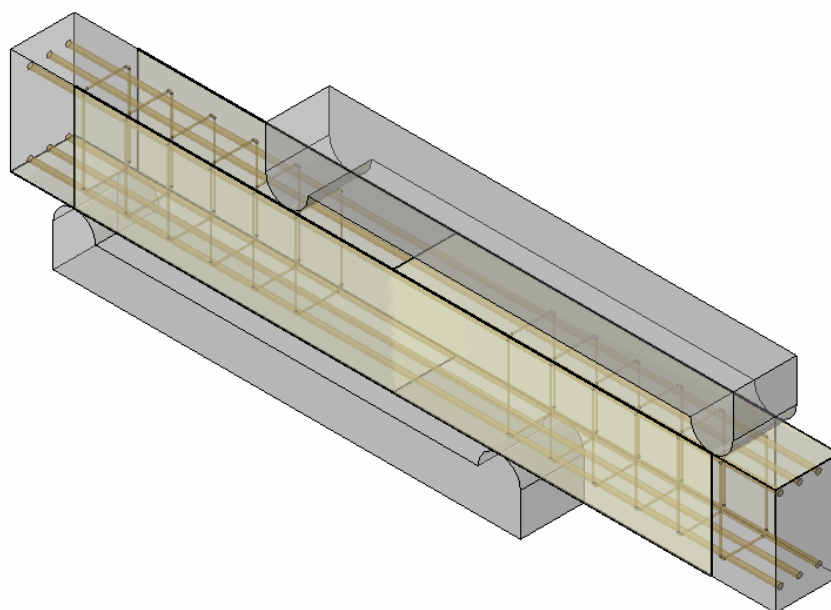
Configuración de ensayo y disposición de la armadura de refuerzo.
